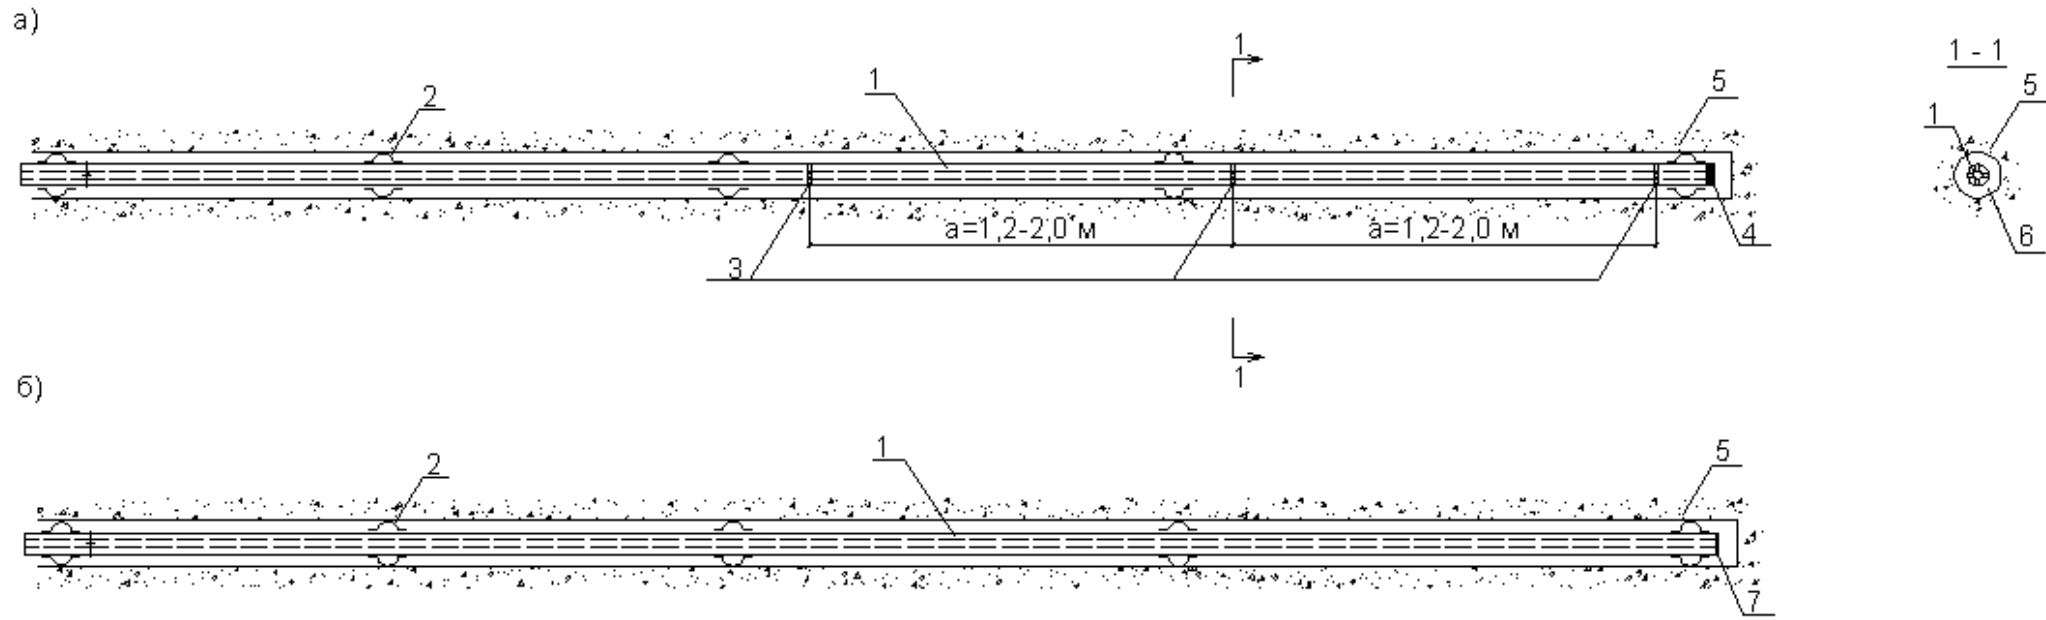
Конструкция армирующего элемента из АНК-С трубчатого сечения
